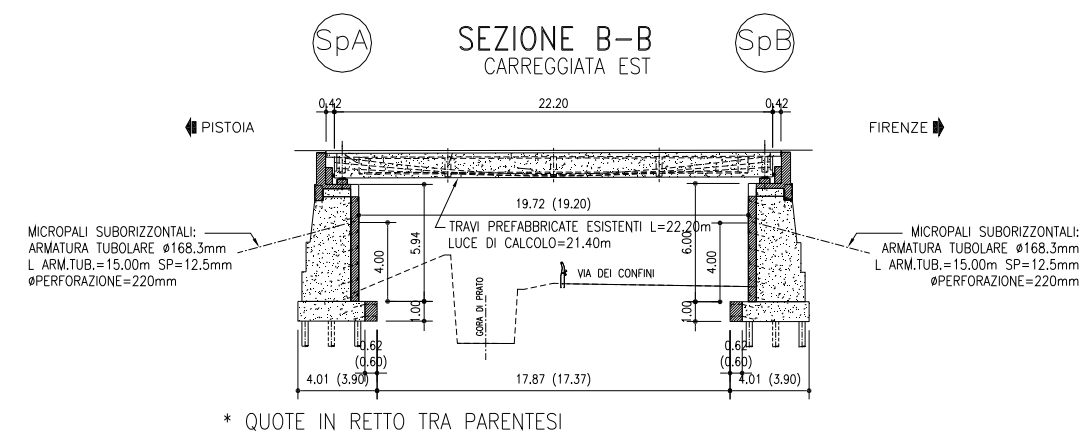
Sezioni longitudinale implacato con spalle
